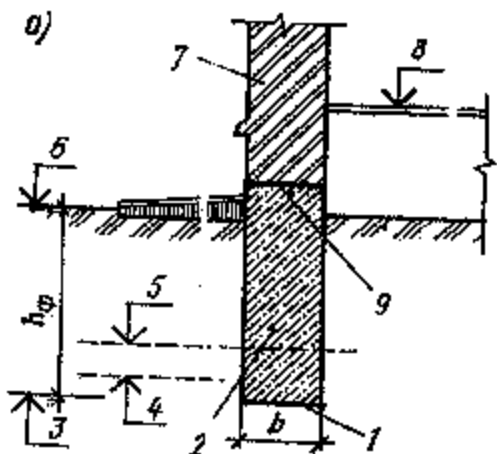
Определение глубины заложения фундаментов: а – схема: 1 – подошва фундамента; 2 – тело фундамента; 3 – отметка глубины заложения фундамента; 4 – отметка глубины промерзания грунта; 5 – отметка уровня грунтовых вод; 6 – планировочная отметка; 7 – стена; 8 – уровень пола первого этажа; 9 – обрез фундамента; $h_{\text{ф}}$ - глубина заложения фундамента; b – ширина подошвы фундамента.
